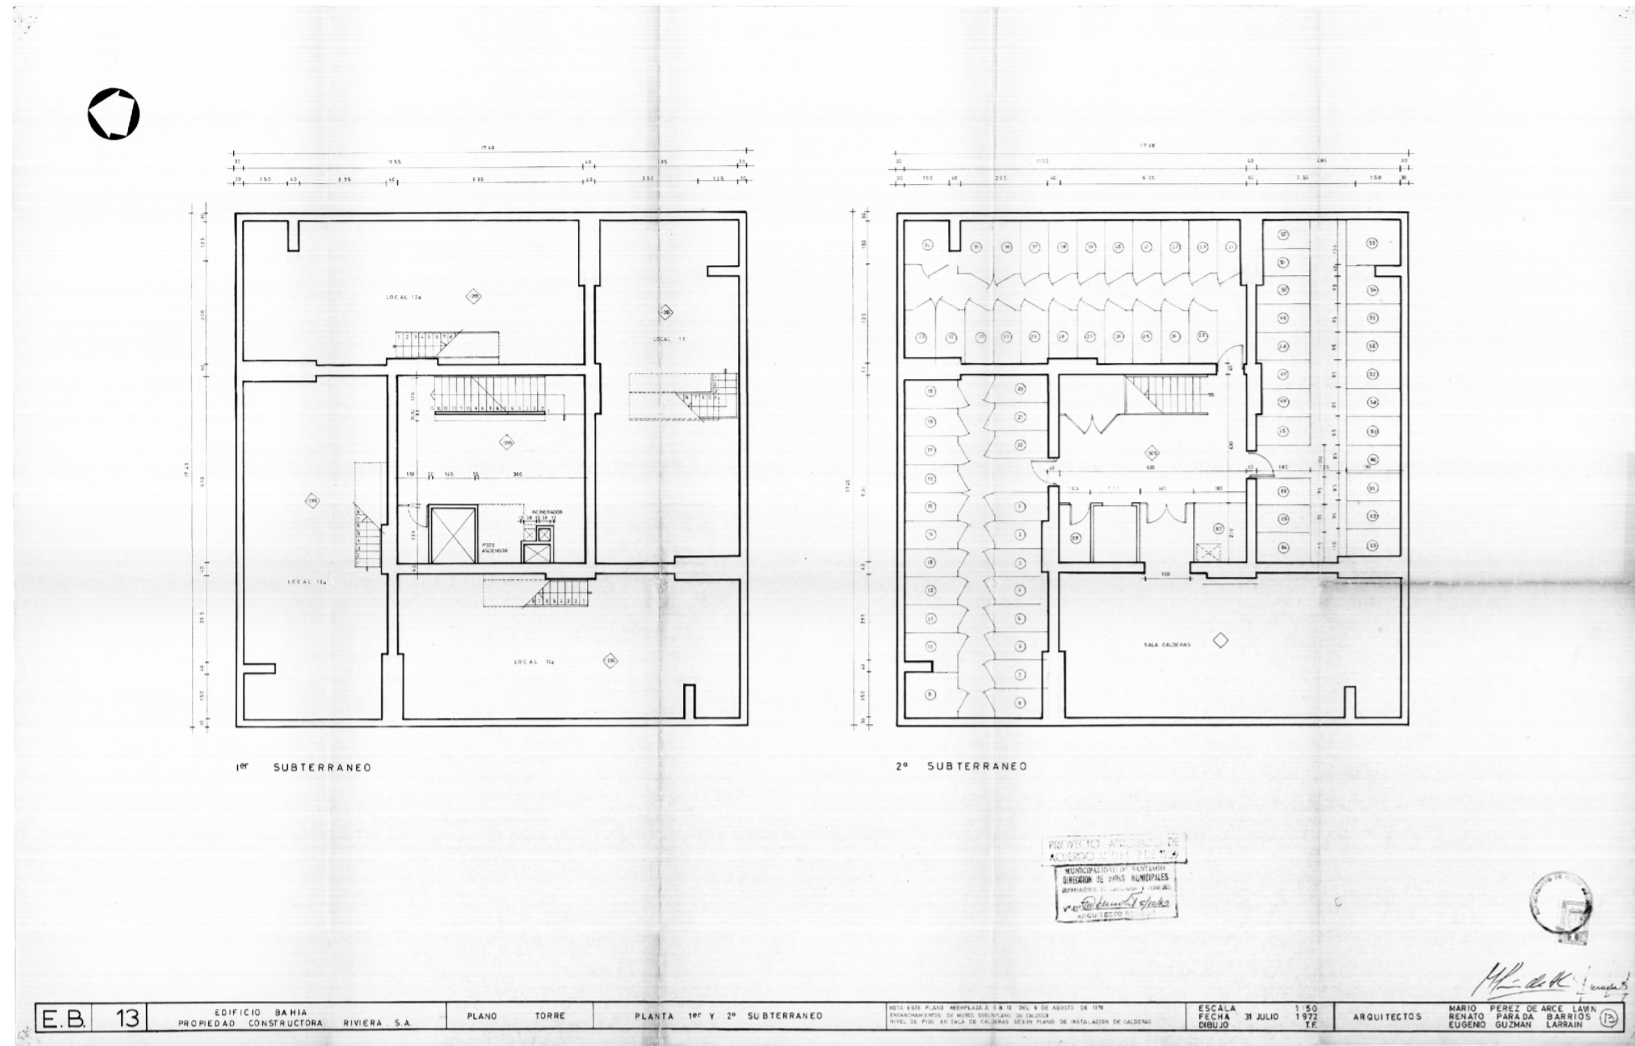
Archivo Plano Municipal. Planta torre nivel subsuelo 01, 02.
